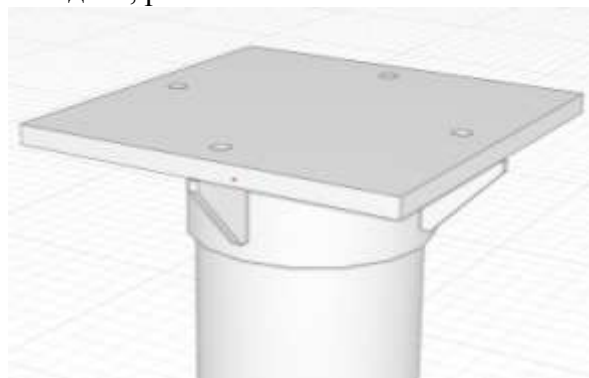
Добавление перекрытия с отверстиями для оголовка сваи
